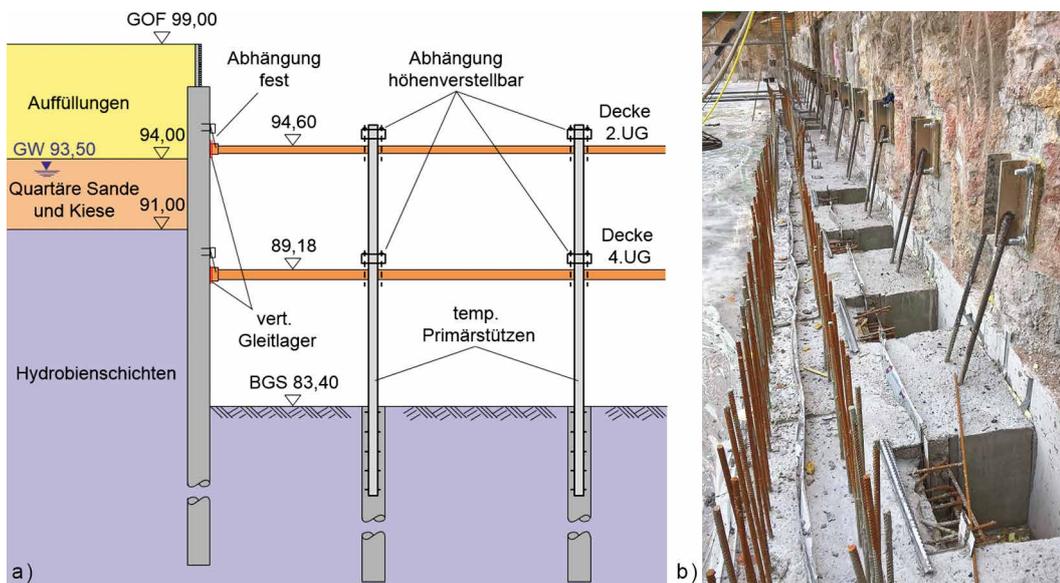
a) Schnittdarstellung der Teildeckelaussteifung, b) Detail der Abhängung am Verbau
